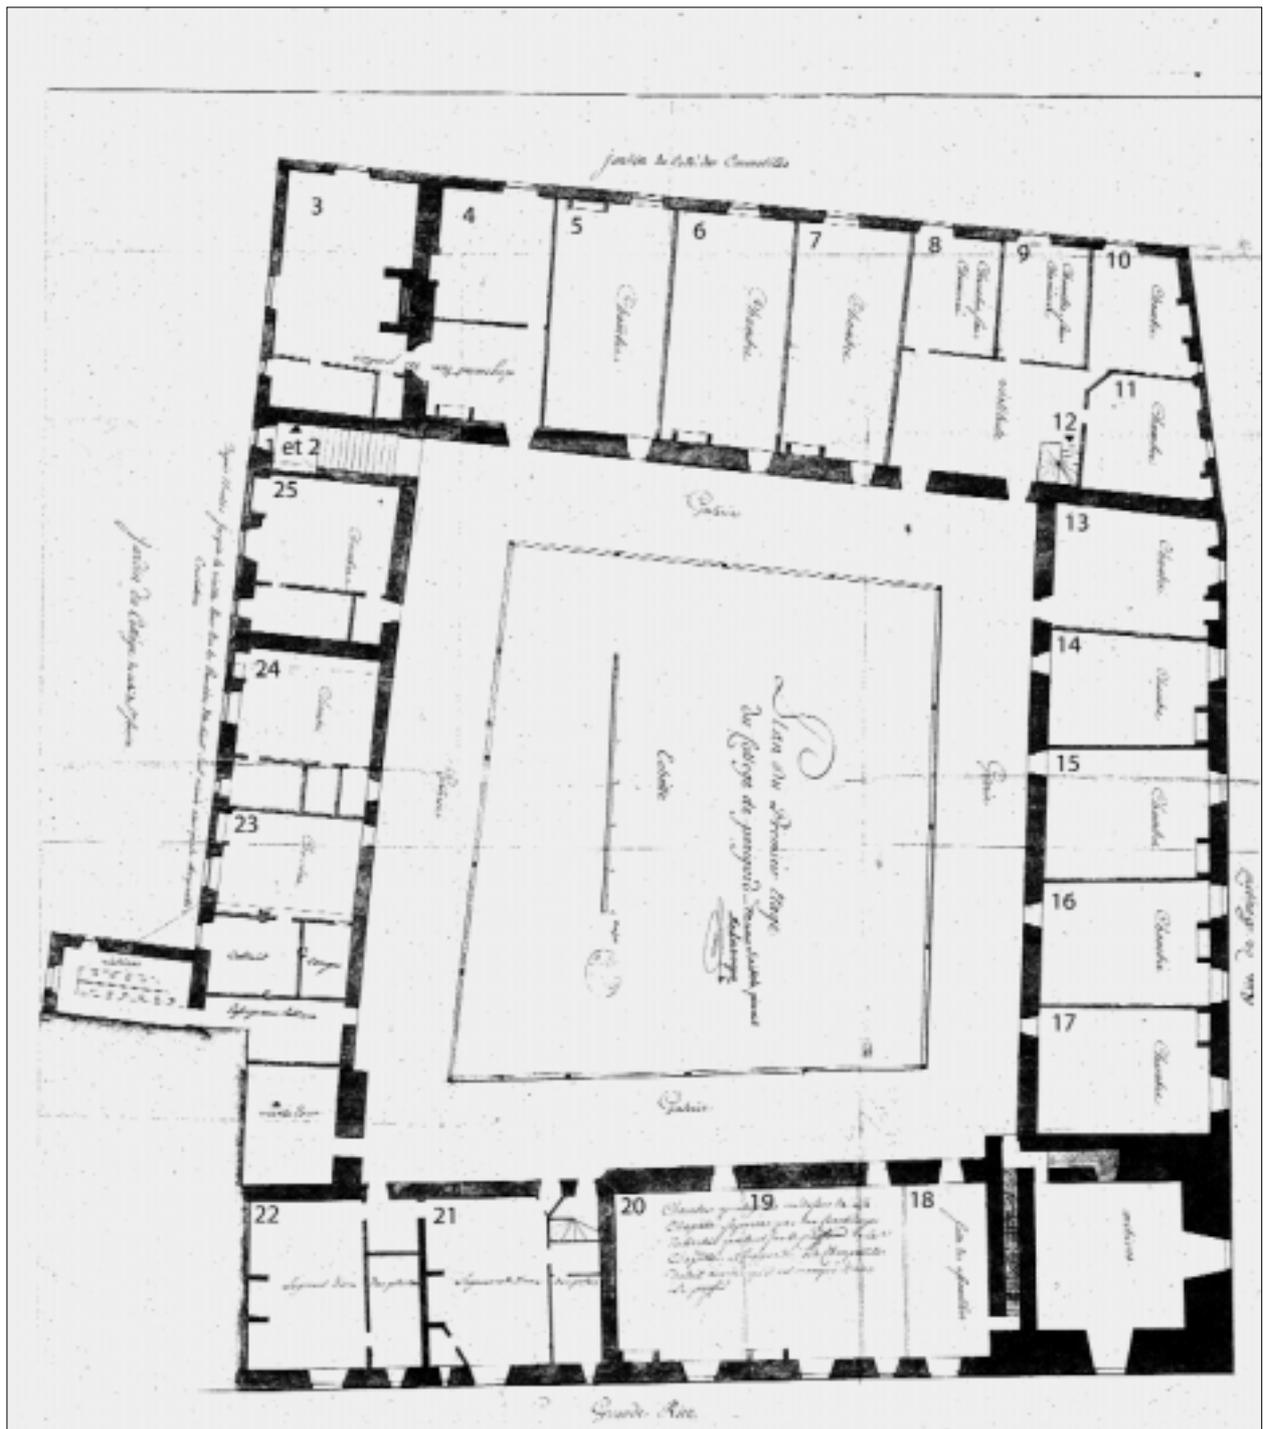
PLAN DU PREMIER ÉTAGE DU COLLÈGE.
